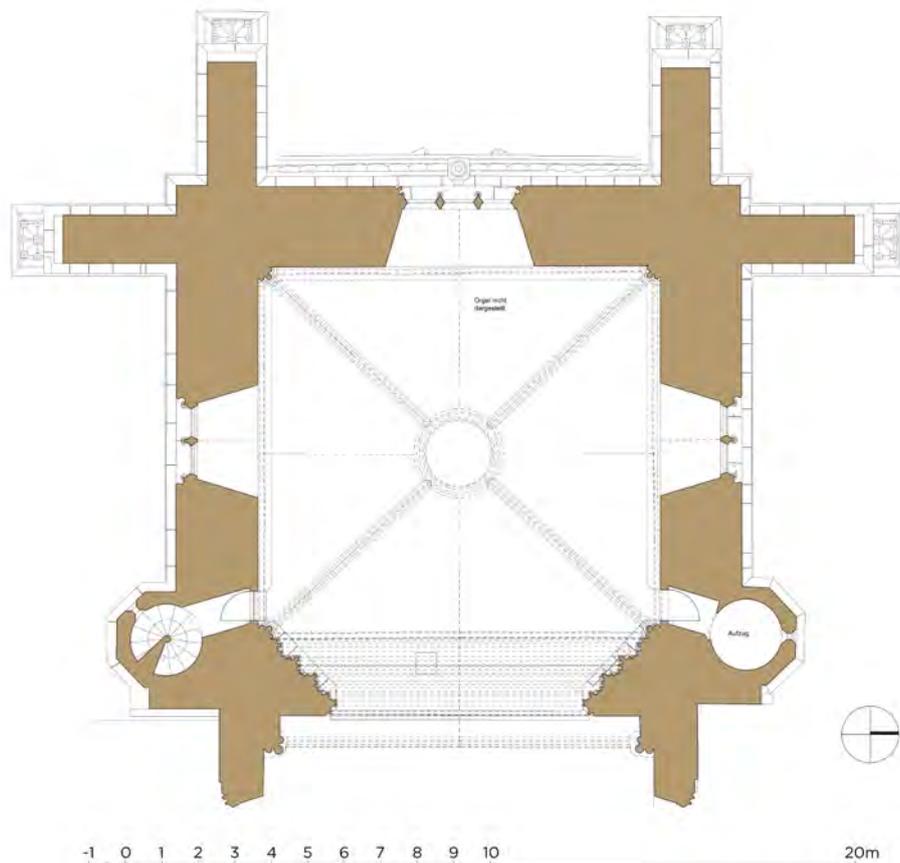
Grundriss der Michaelskapelle, geschnitten knapp über dem vierten Sims
